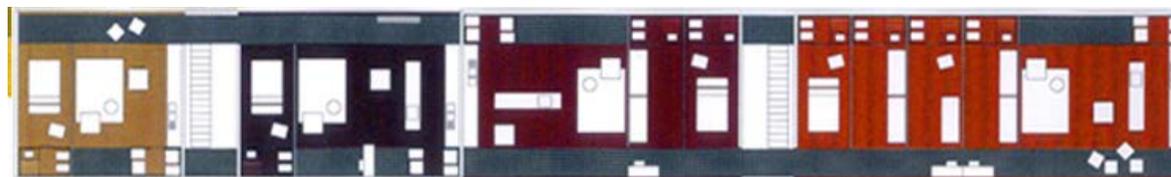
Planta de análisis y comprobación de la correcta disposición del soporte y las unidades separables.
